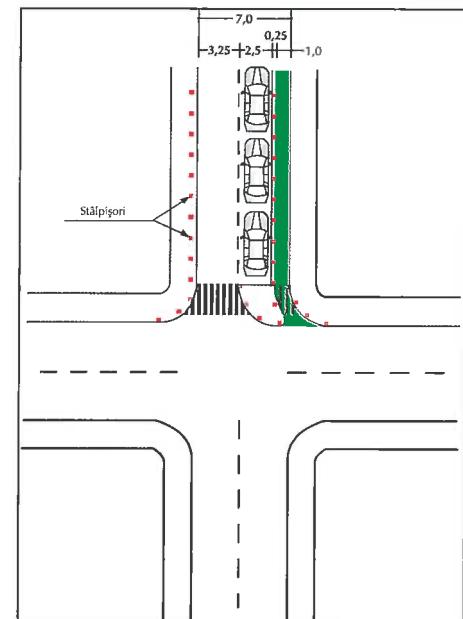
Soluție de amenajare a străzilor (vedere în plan)
